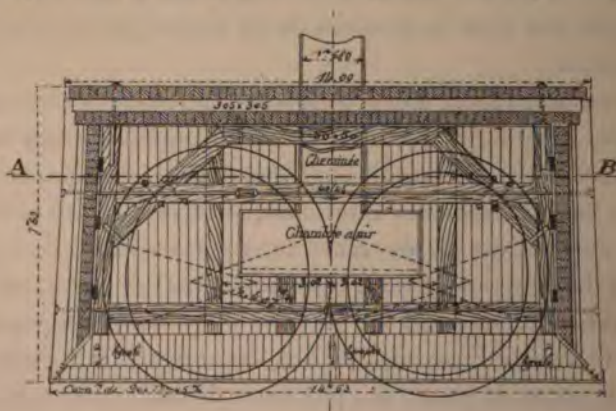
Coupe en travers du caisson. — Côté New-York.
